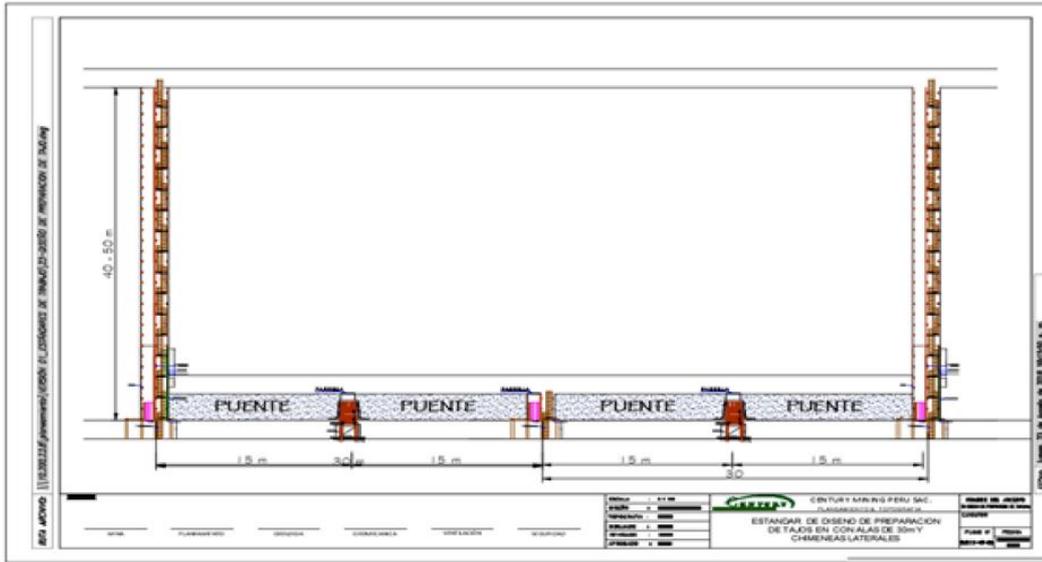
Esquema de preparación de tajeo con chimeneas laterales dobles y alas de 30 m Tomado del Departamento de Planeamiento
